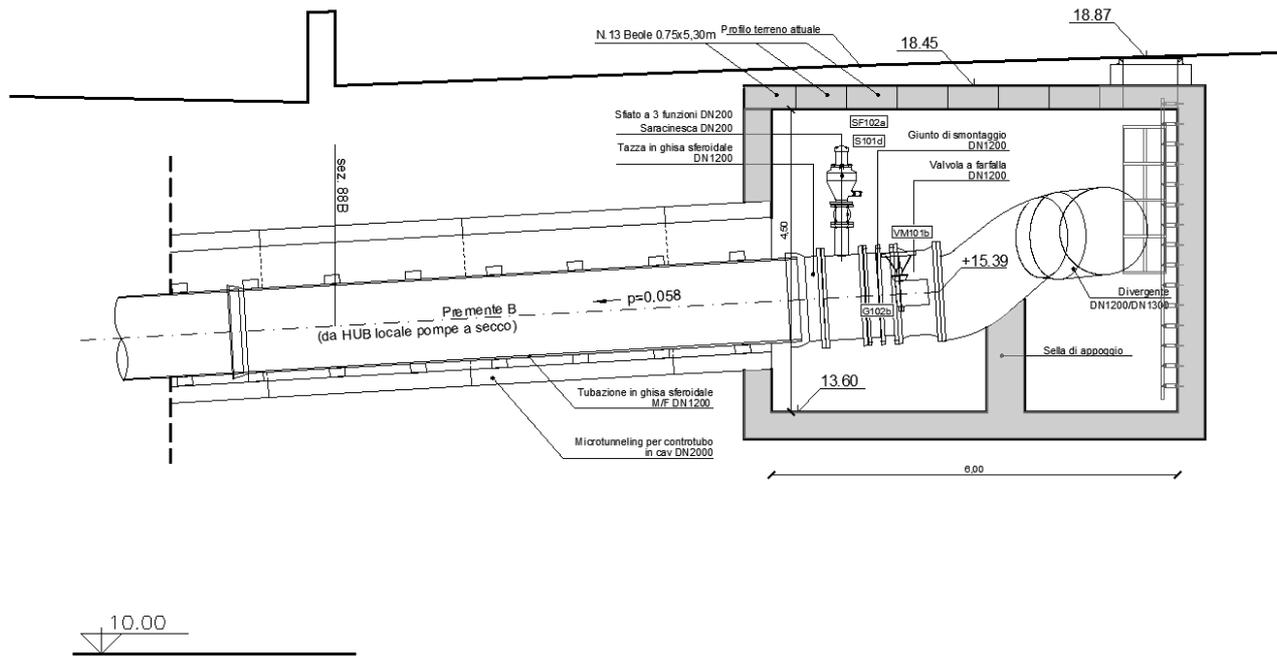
Microtunnel – Camera di arrivo: Sezione longitudinale
